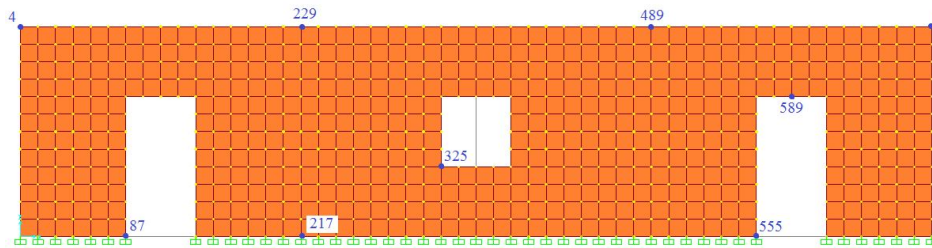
Construção 4.2, rotura por compressão (1)
